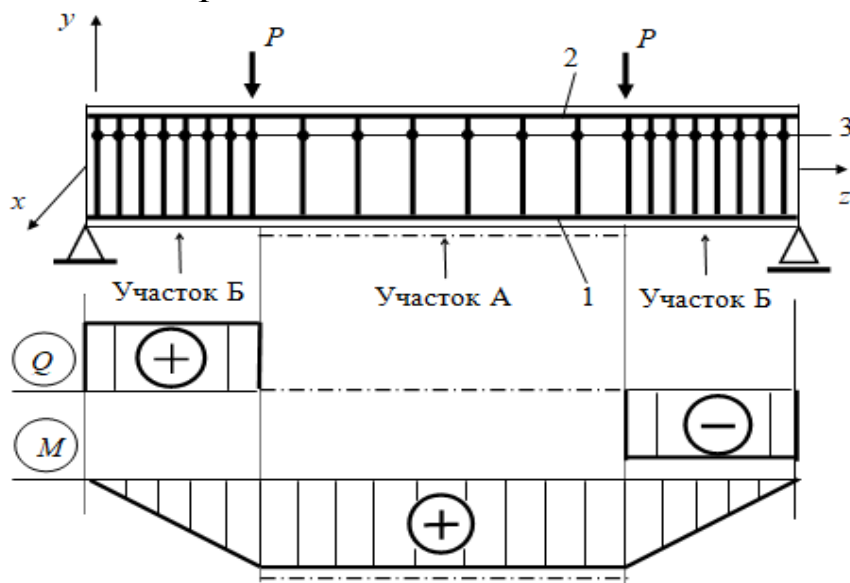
Расположение поперечной арматуры в железобетонной балке:
